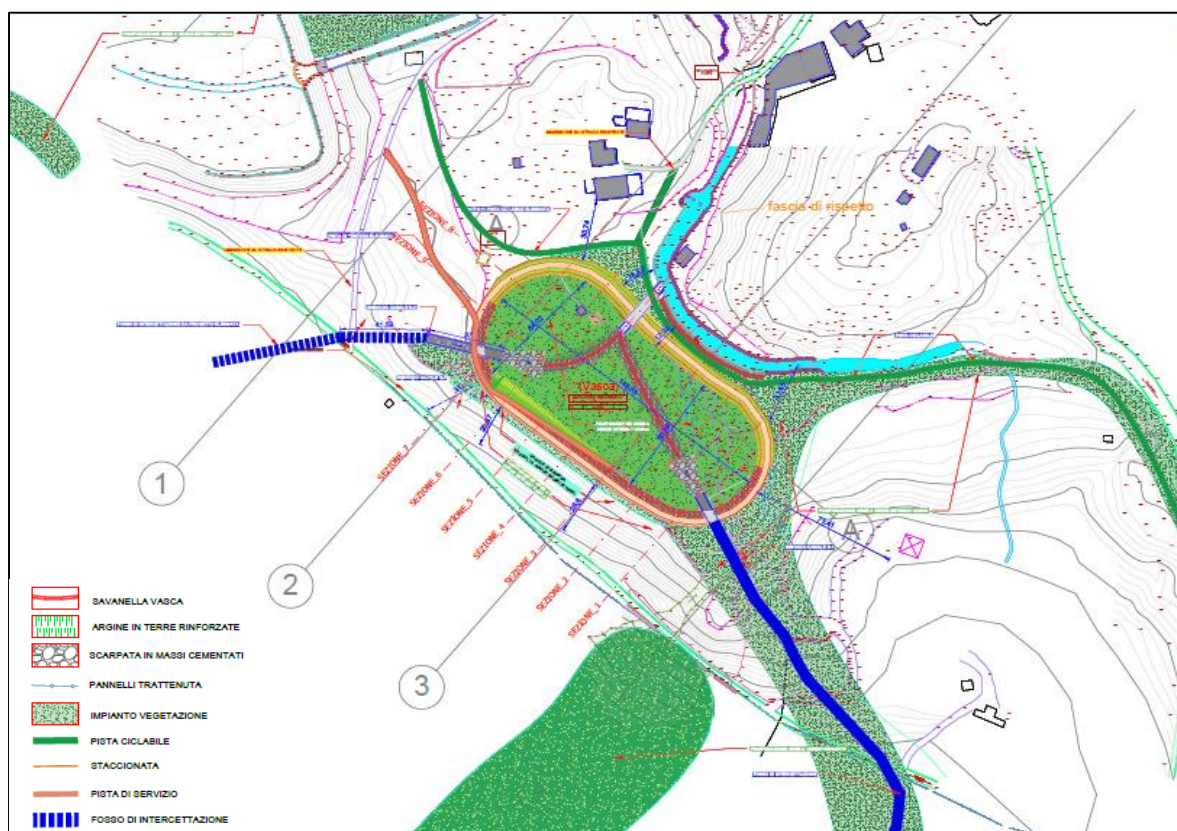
Planimetria generale Progetto ORIGINARIO
